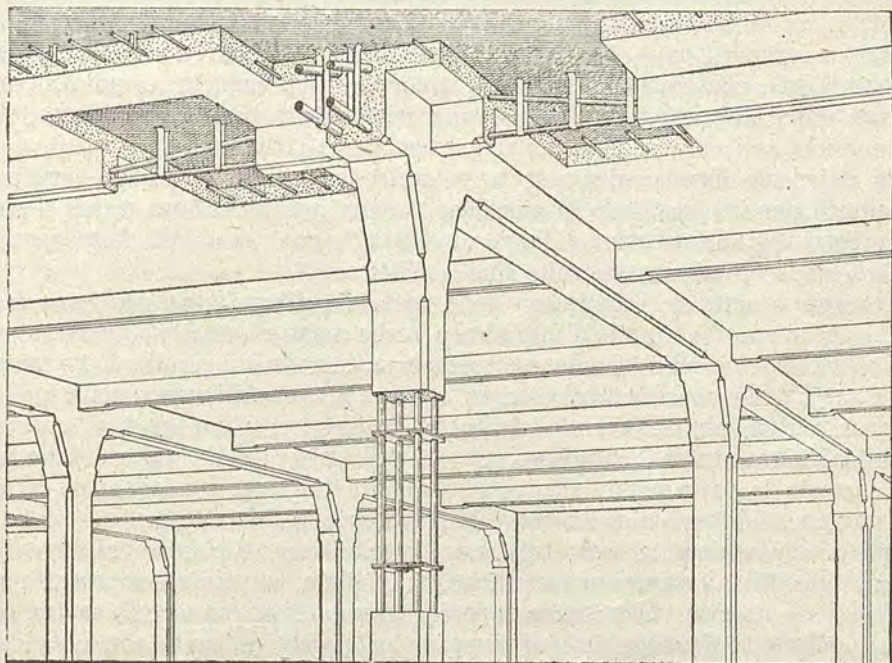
Solaio di calcestruzzo armato (sistema Hennebique) costituito da travi principali appoggiate a pilastri, e da travi secondarie.
